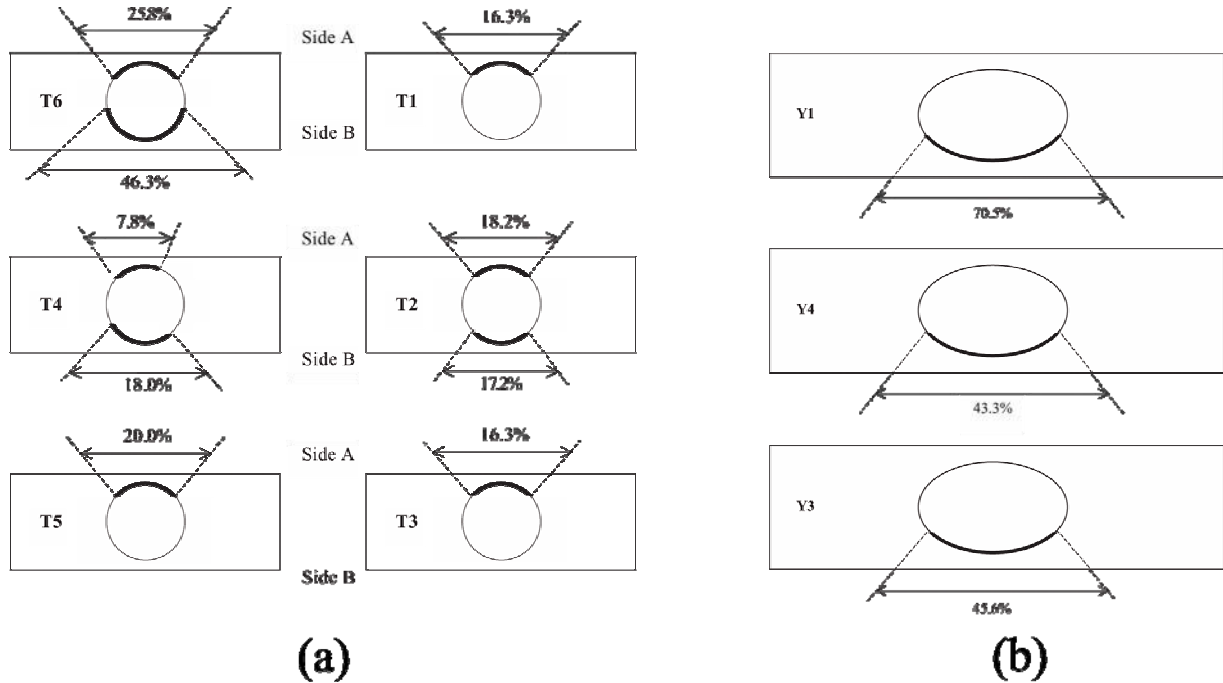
Pourcentage et position des zones fissurées (a) éprouvettes de forme T; (b) éprouvettes de forme Y
